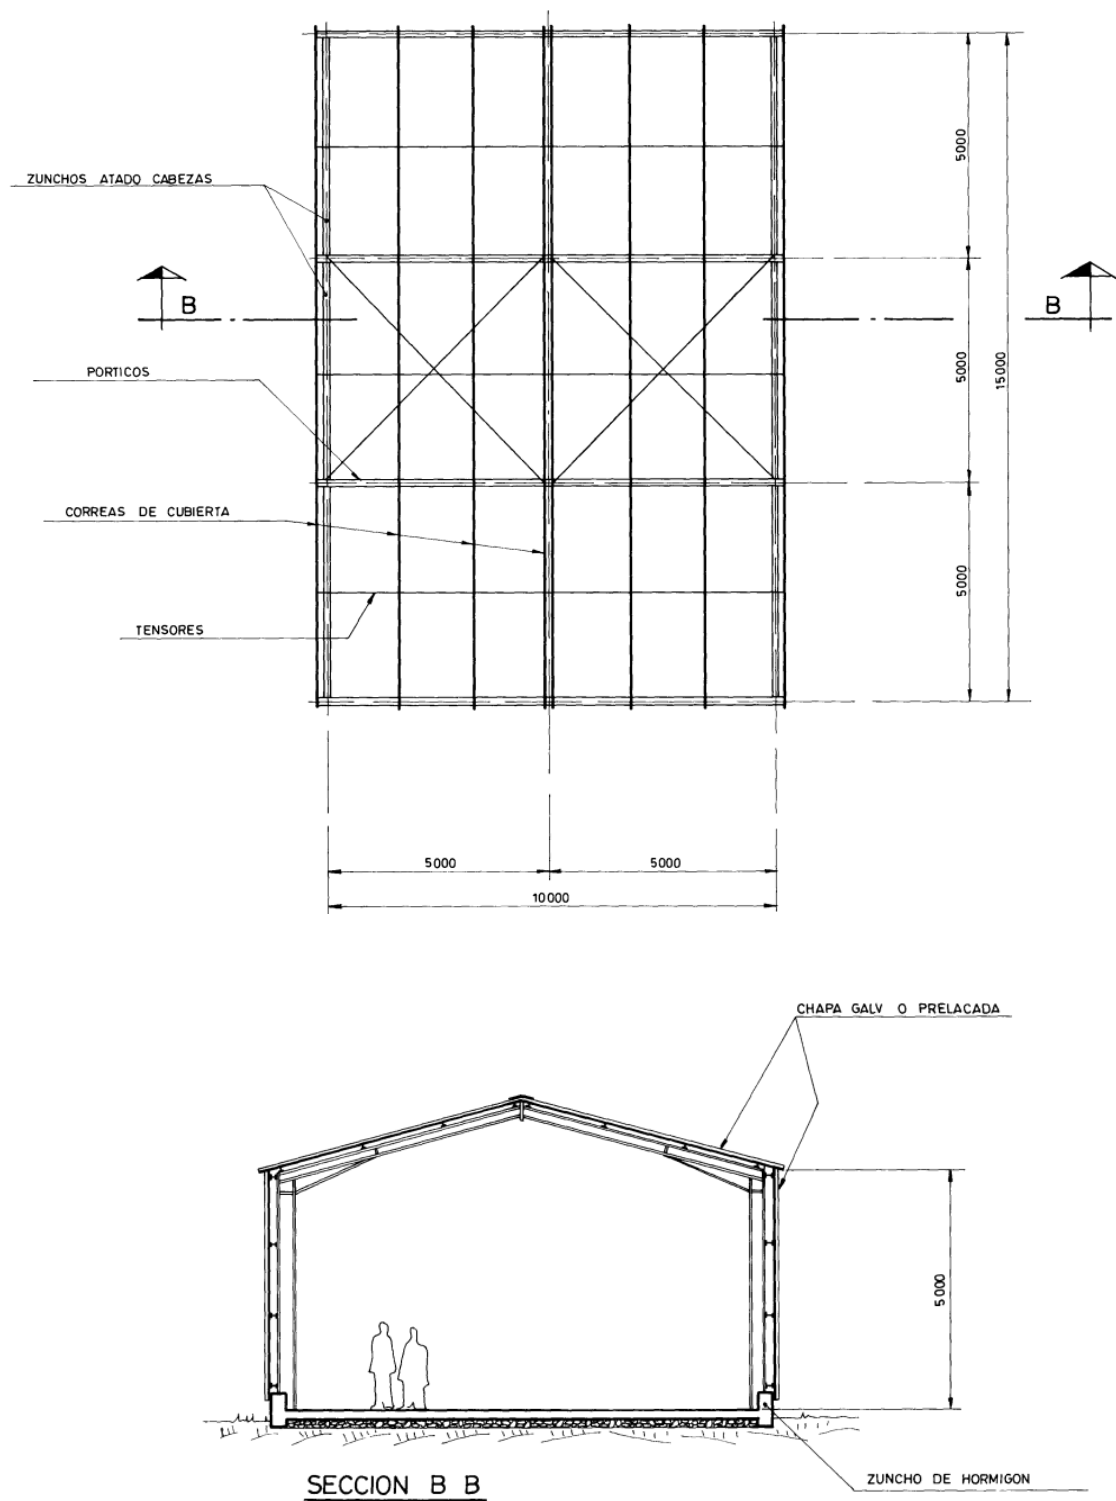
Sección y dimensiones en planta del almacén C5. (extraído de plano 05.18.11/4).
